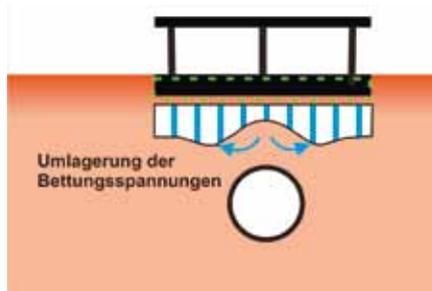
Umlagerung von Bettungsspannungen an einem Bestandsbauwerk infolge Tunnelvortrieb
